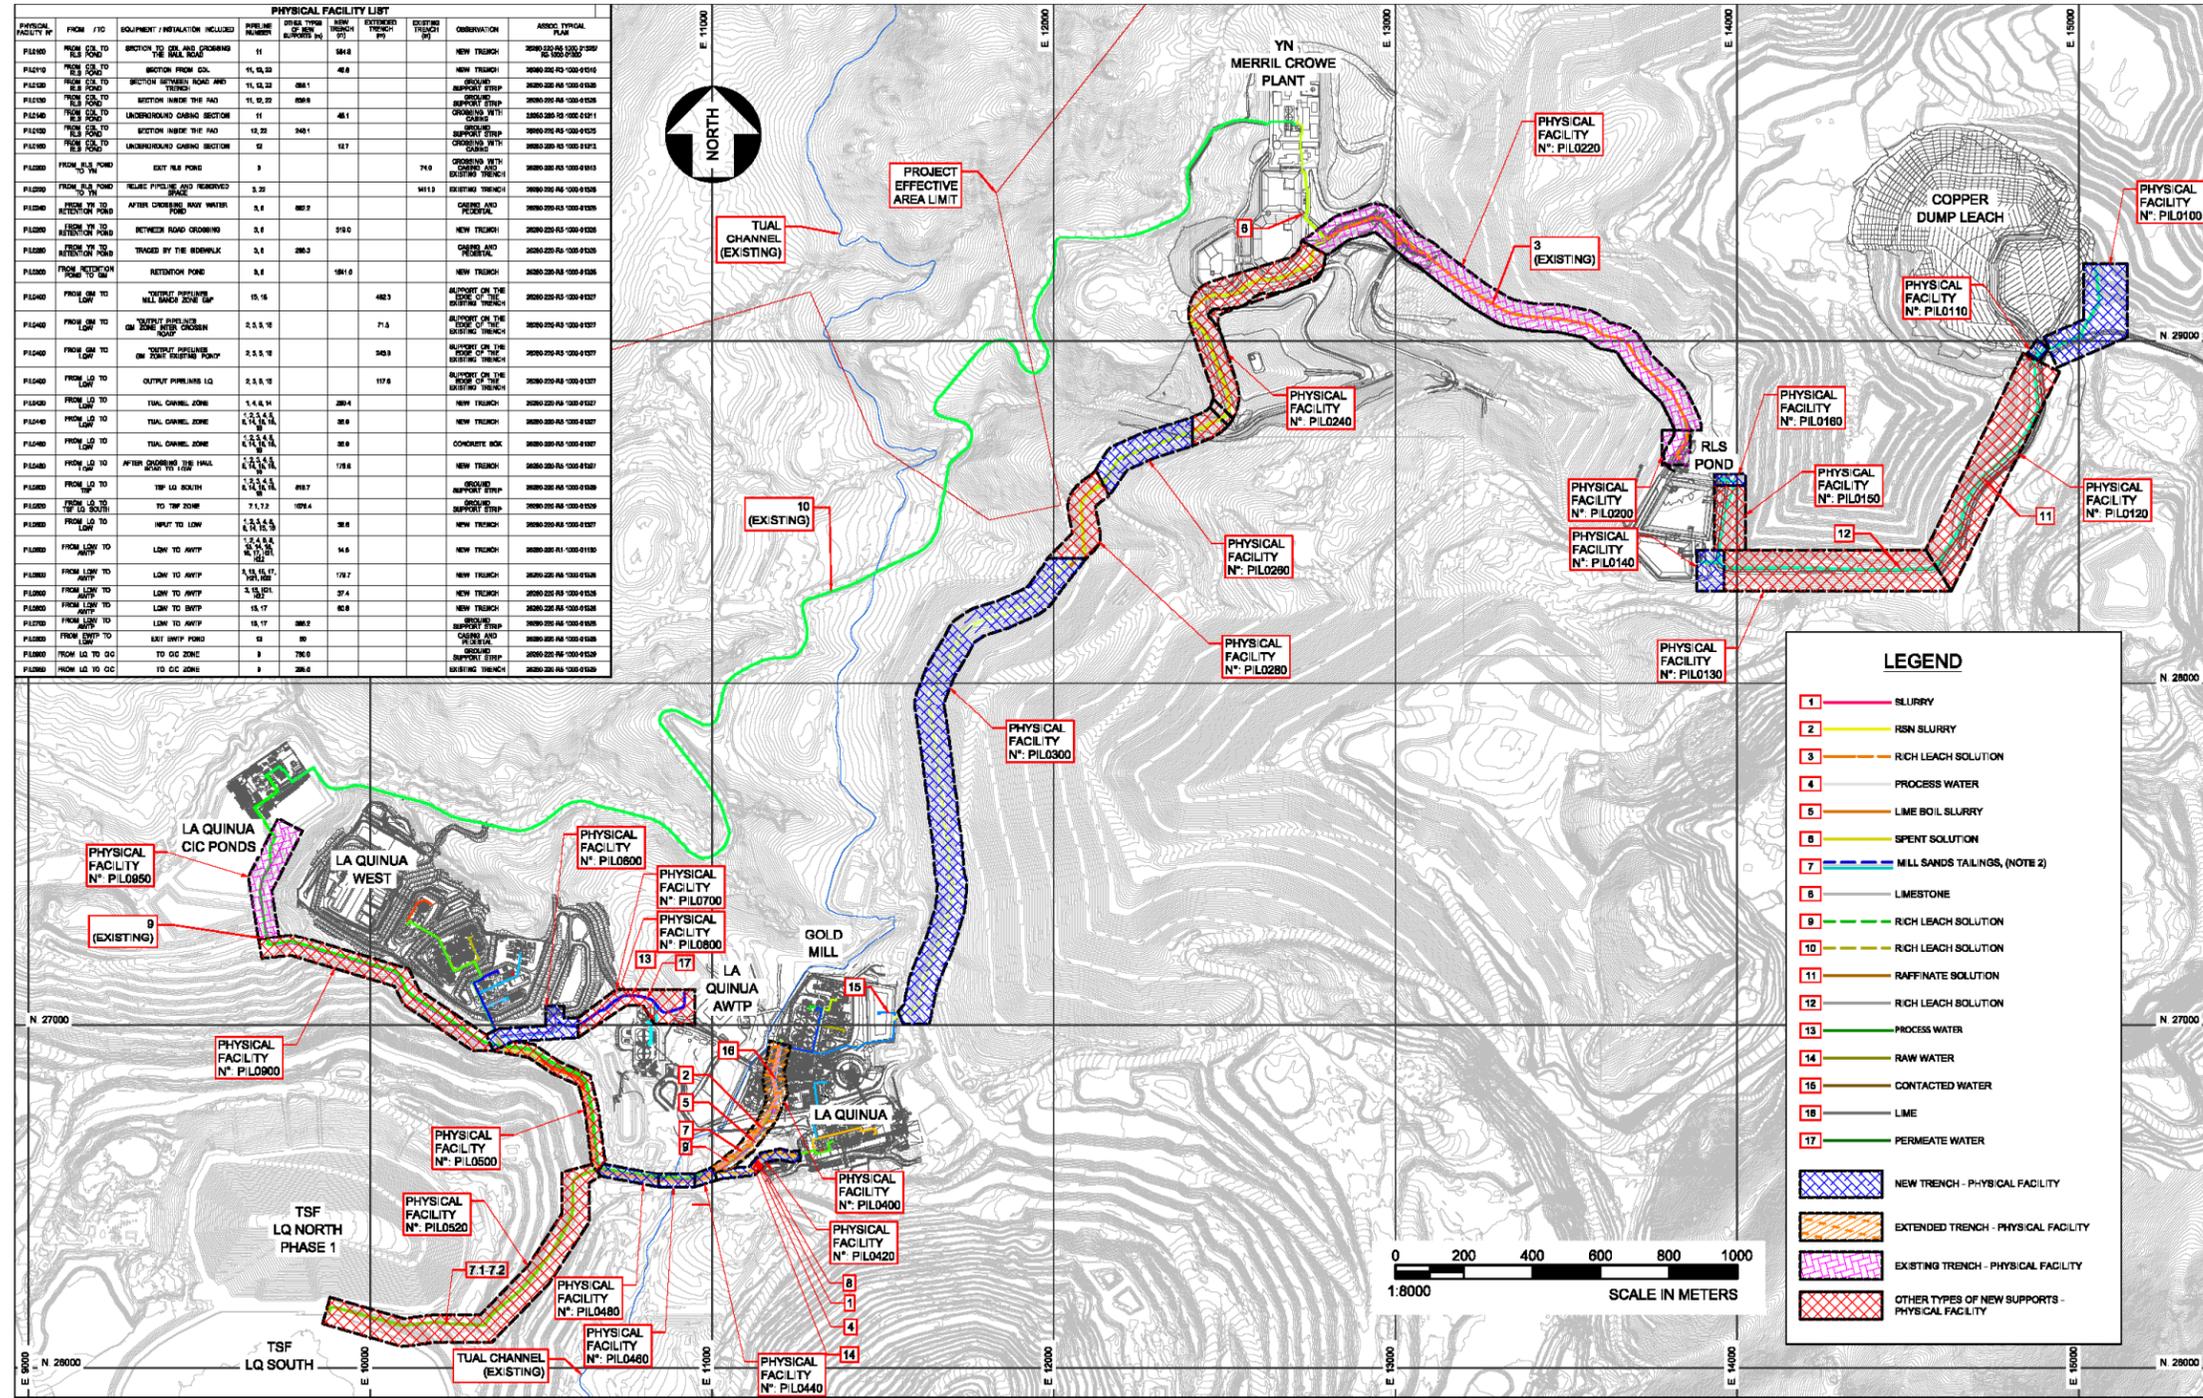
Disposición de instalaciones de planta y trincheras.
